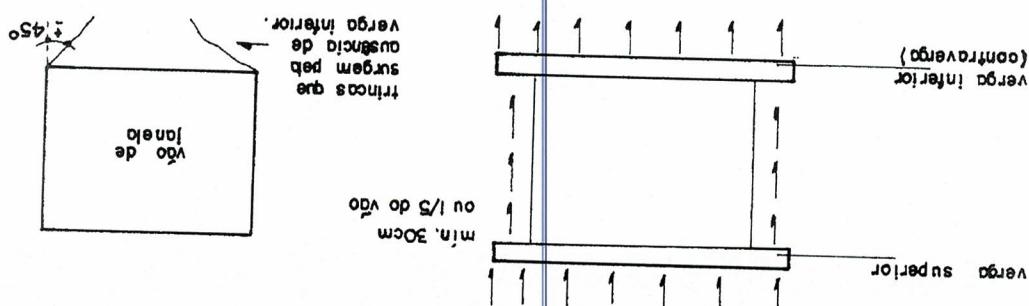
Vergas em alvenaria de tijolo furado para vão ate 1,00m e entre 1,00m e 2,00m.
